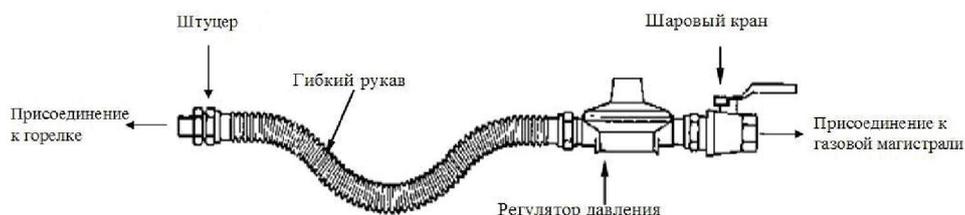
Схема подключения воздушонагревателя к газовой магистрали.
